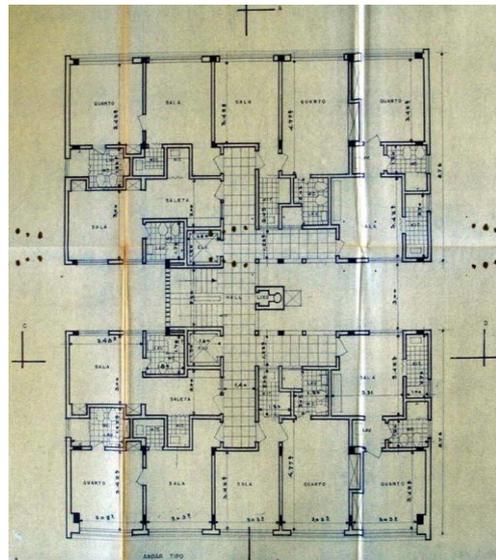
Edifício para a Indústria e Comércio Motta S/A, planta baixa pavimento tipo.
